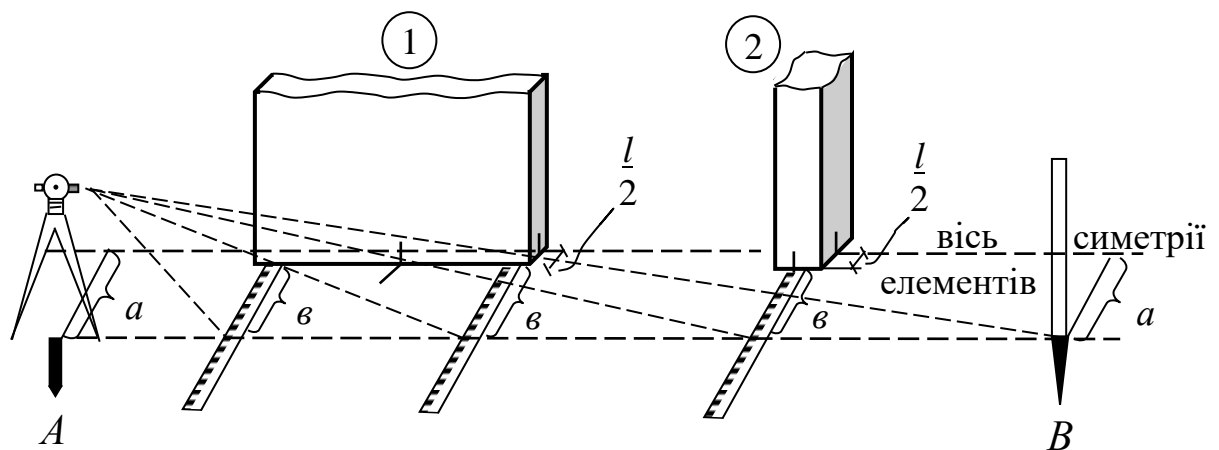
Схема способу бокового нівелювання: 1 – монтаж панелей; 2 – монтаж колони
